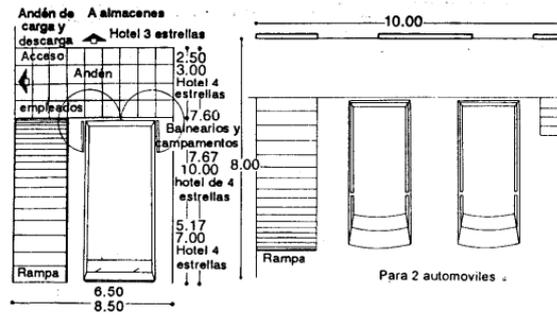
Planta tipo Zona de Carga/ Descarga
